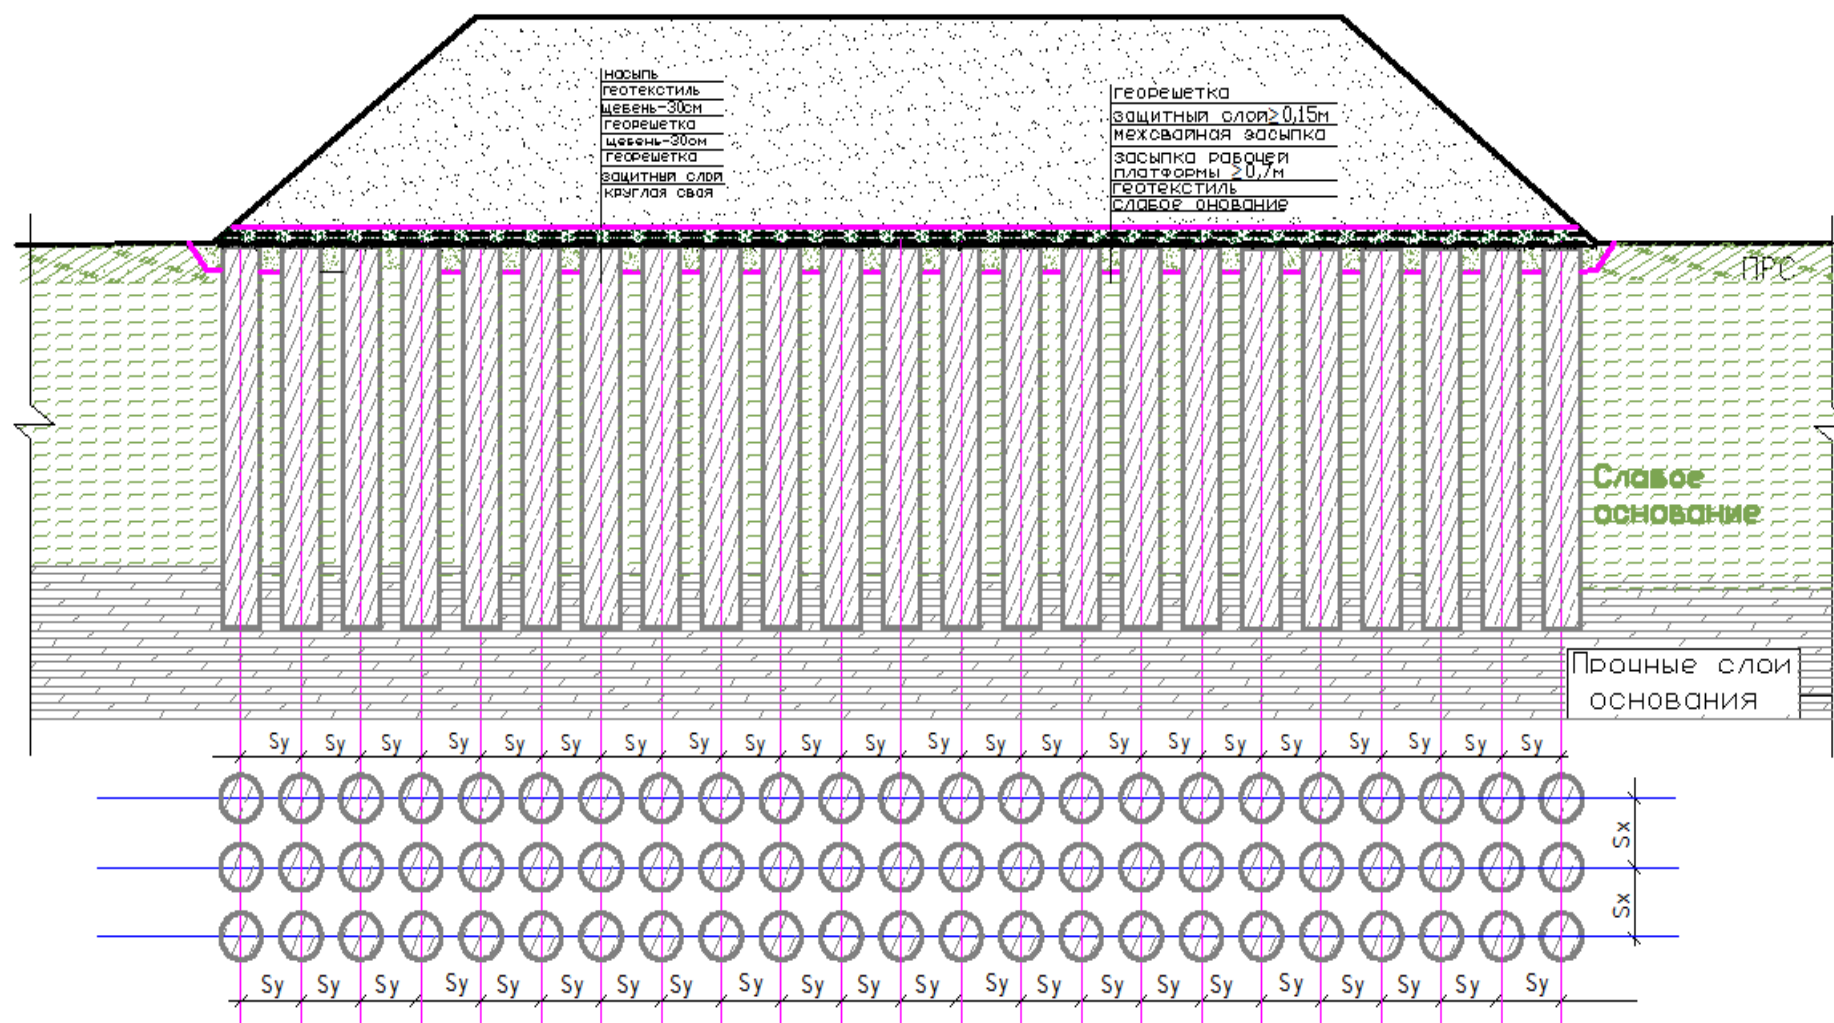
Гибкий ростверк из двух слоев георешетки со щебнем на круглых сваях (с размещением свай по квадратной сетке)
